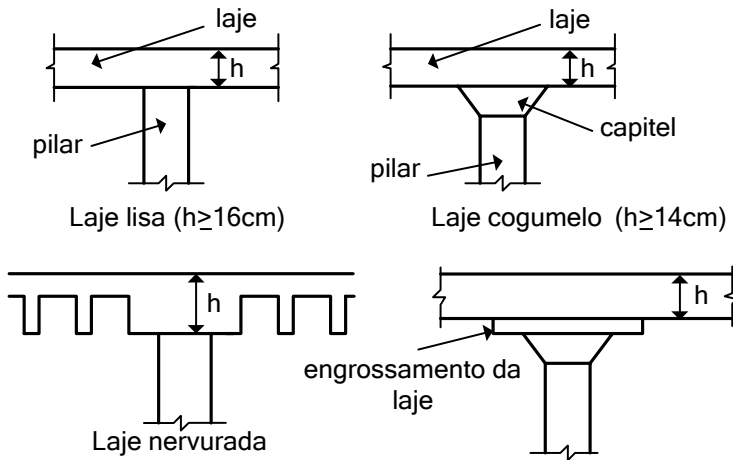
Lajes lisas e lajes cogumelo
